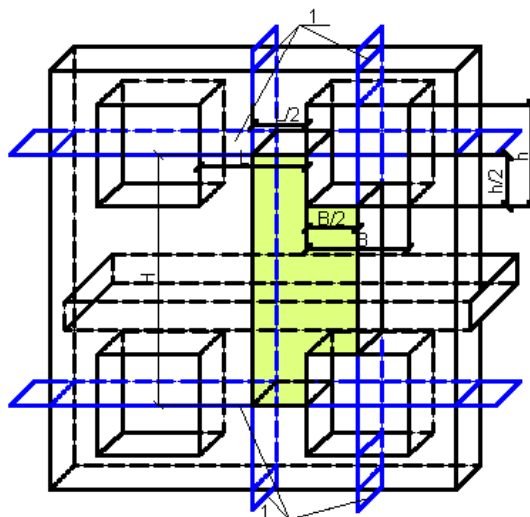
Пример разбиения на расчетные участки наружных стен на фрагменте плана этажа
